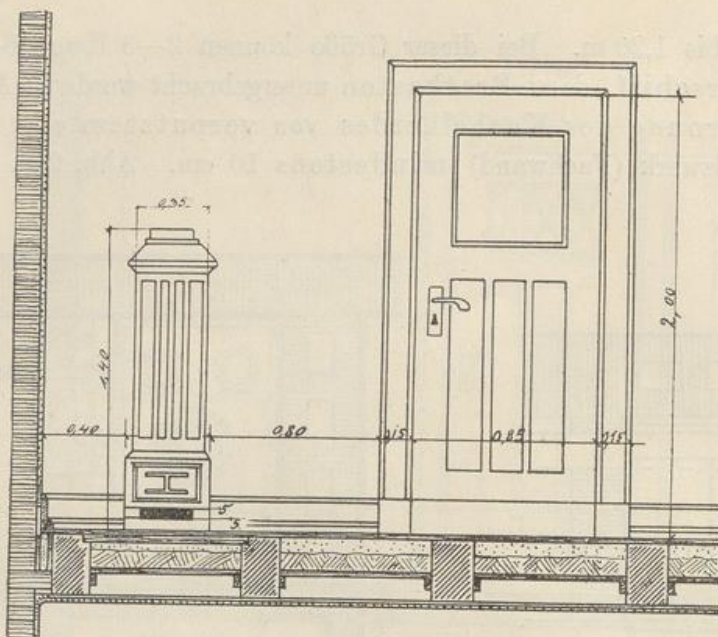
Eiserner Ofen vom freien Holzwerk 0,80 m entfernt. Massivschicht und Hohlraum unter Ofen.
